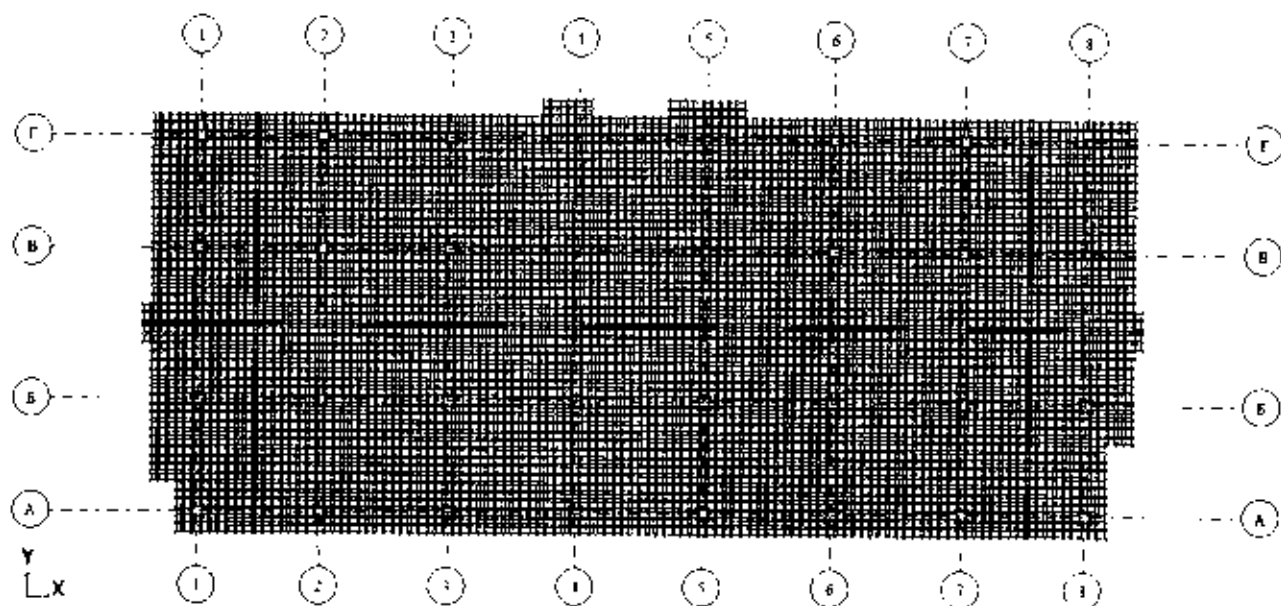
Общий вид расчетной схемы фундаментной плиты
